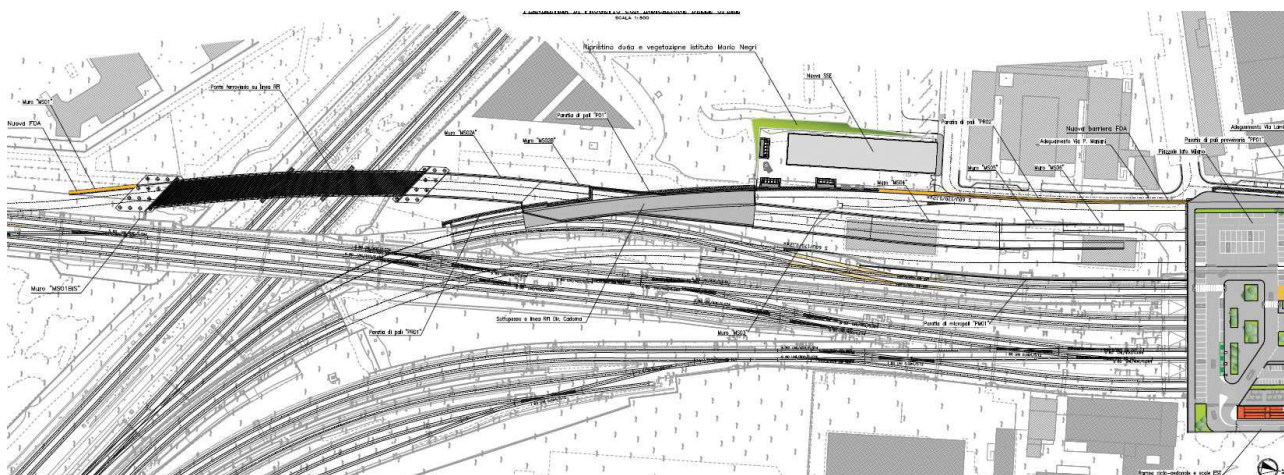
Planimetria di progetto (da Ponte su RFI a FV)
